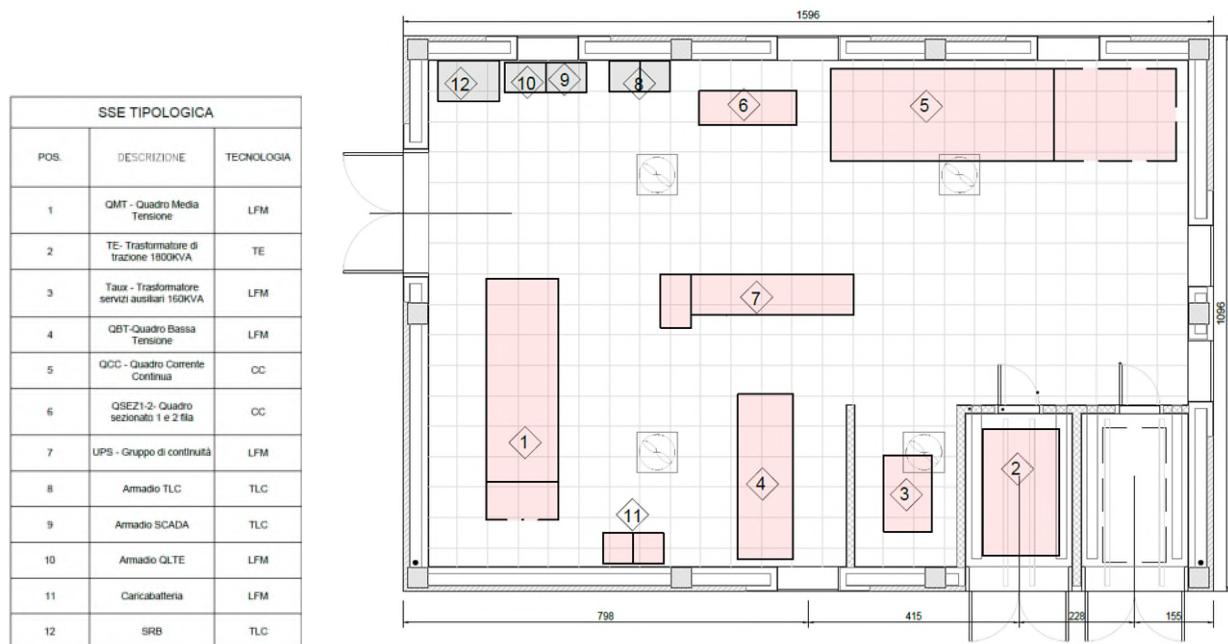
Planimetria SSE / tipologico (elab. B382-4.2-SF-LAC-PI-001-D)
